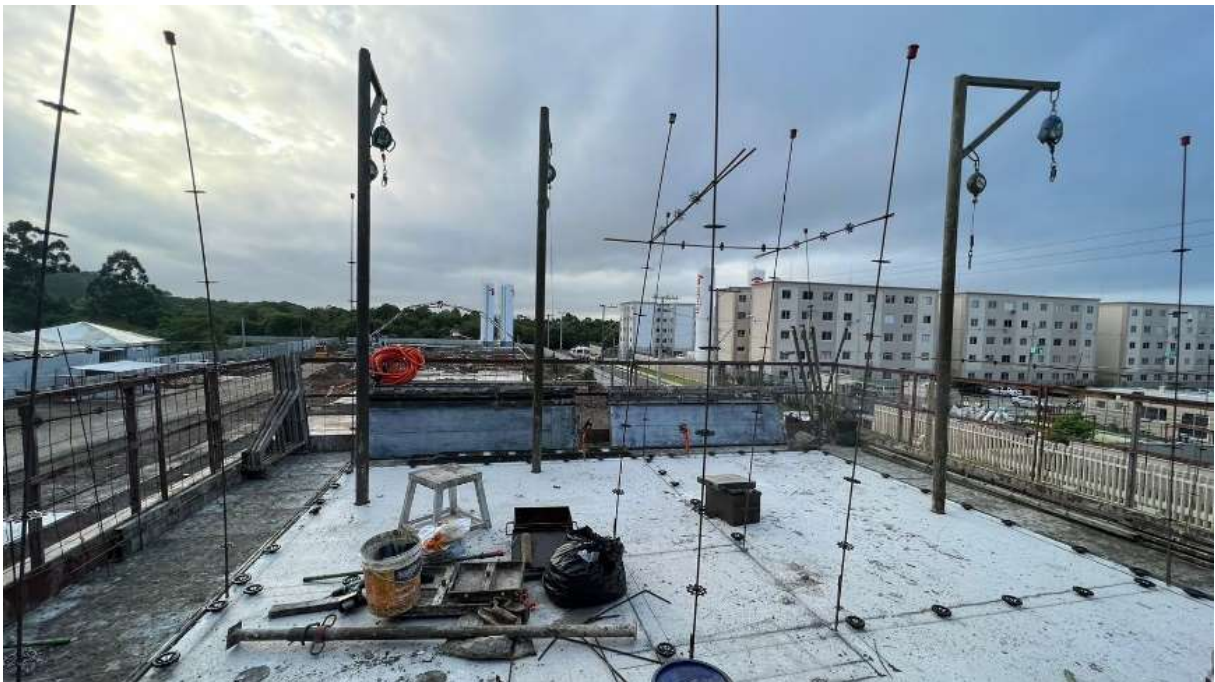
Levante de armação de uma parte do segundo pavimento (Fonte: o autor).
